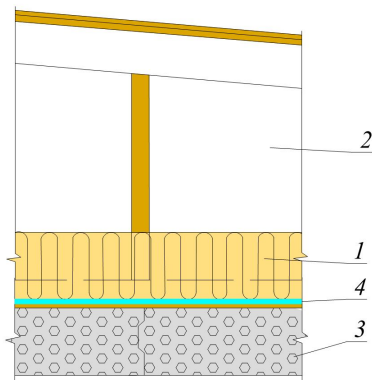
Конструкция чердачного перекрытия из пористого бетона: 1 – тепловая изоляция; 2 – чердачное помещение; 3 – слой пористого бетона; 4 – пароизоляция
